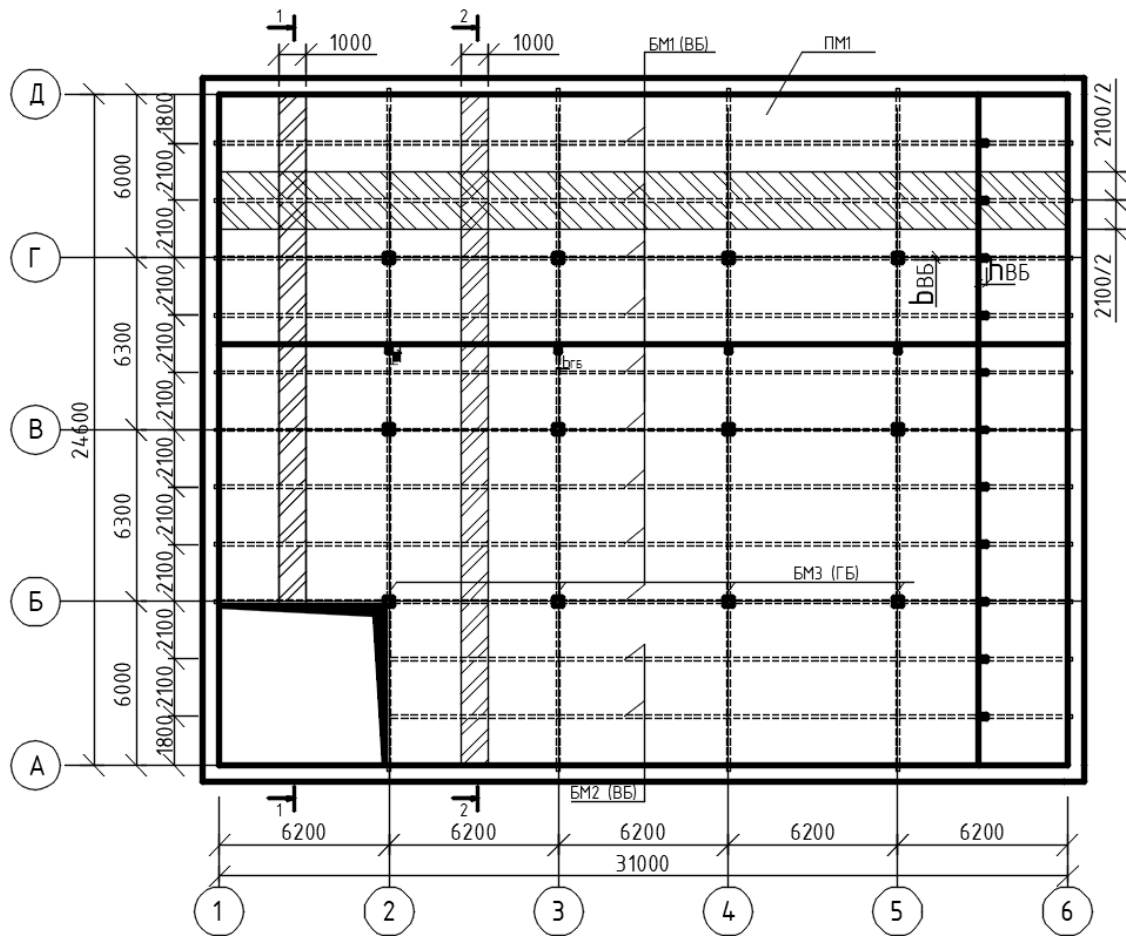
План монолитного перекрытия с условно вырезанными полосами для расчета величины погонной нагрузки
